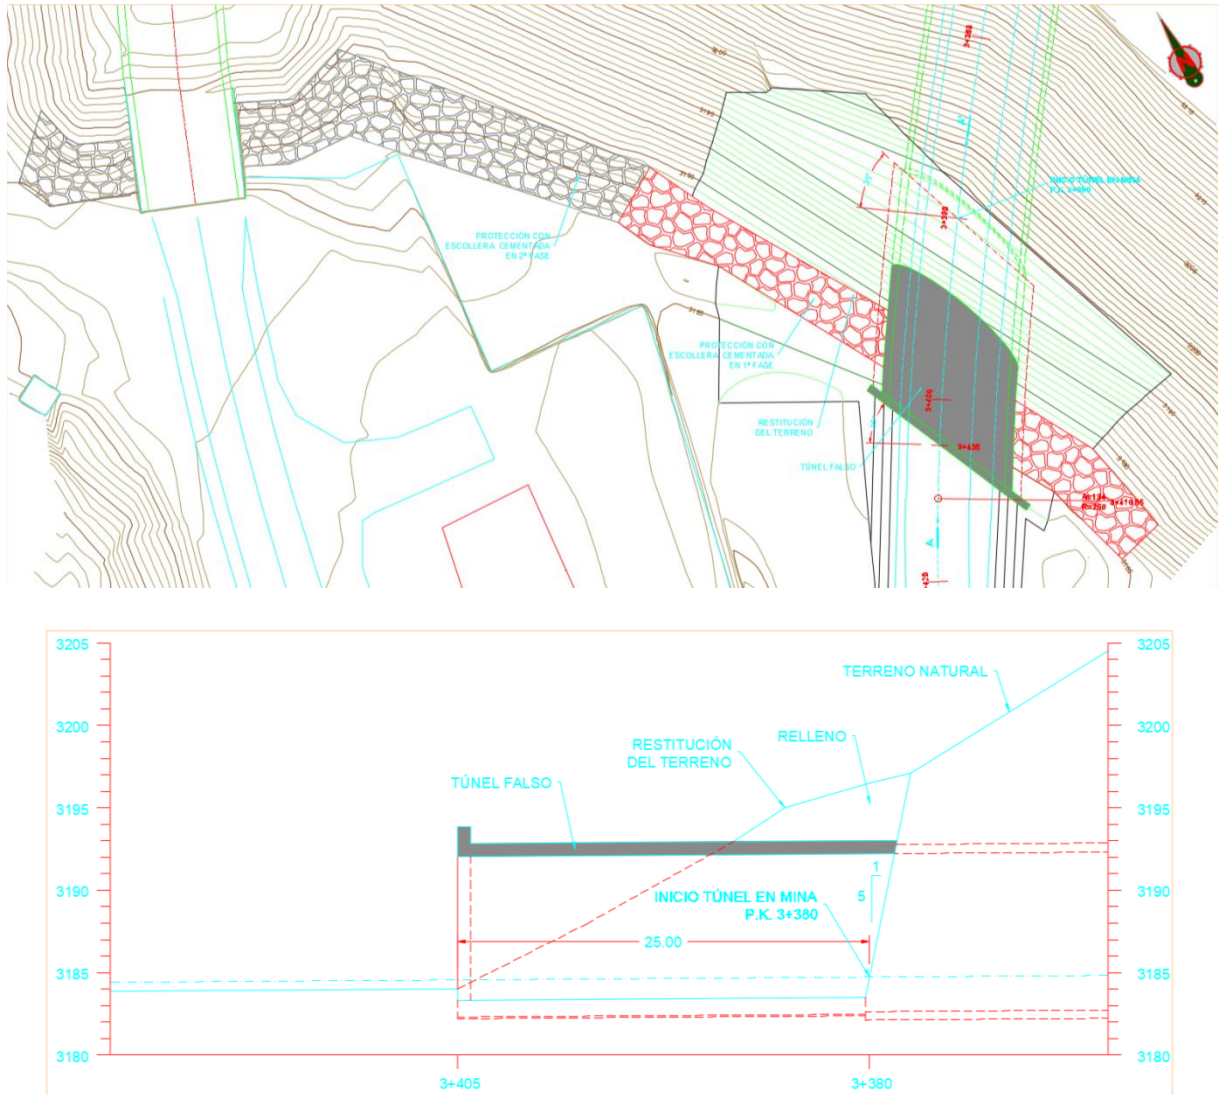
c.- Portal Chileno. Relleno en planta y alzado.
